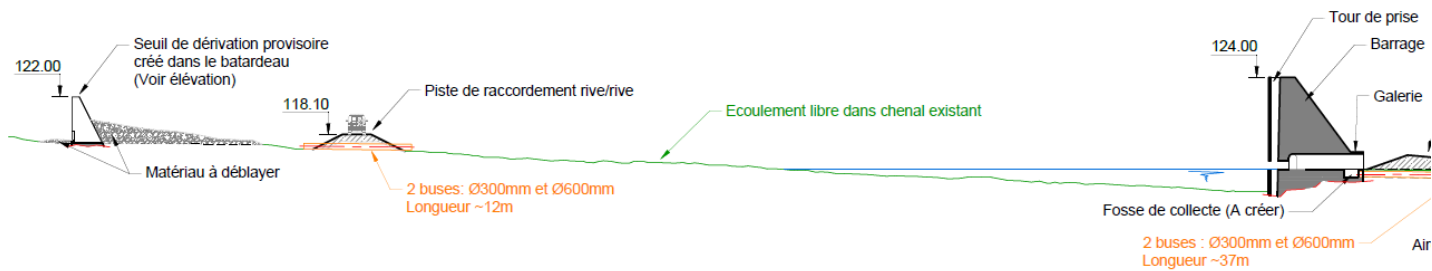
Coupes verticales de la tour de prise d'eau Plan « PRISE 02 » du dossier de plans
